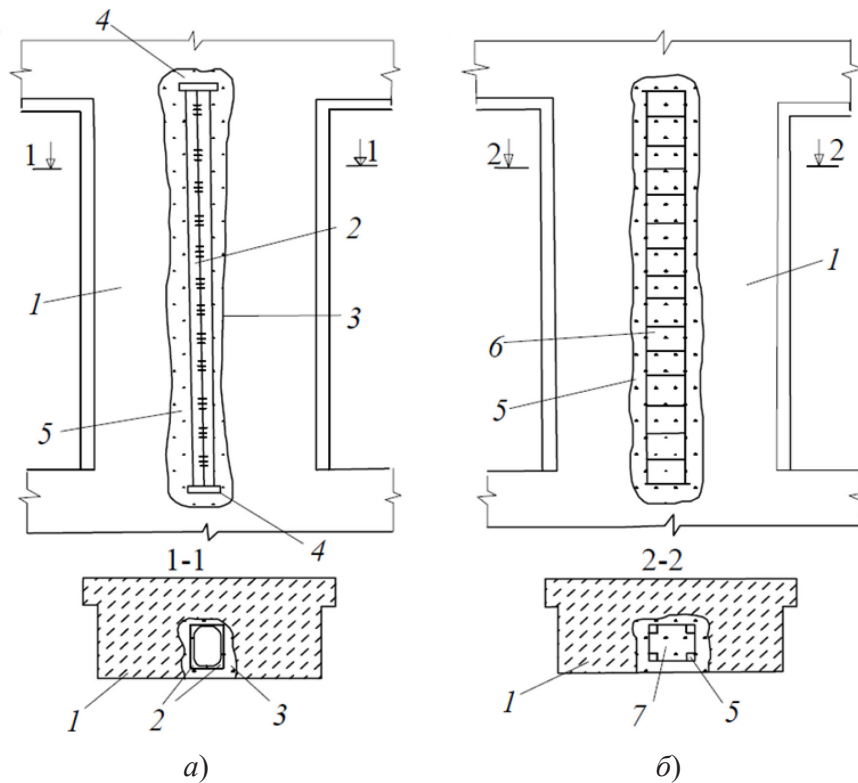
Усиление каменных простенков сердечниками: *а* – стального; *б* – железобетонного; *1* – усиливаемый простенок; *2* – стальной сердечник из двух сваренных швеллеров № 14; *3* – бетон класса В10–В15; *4* – опорная пластина; *5* – вертикальная штраба, прорезанная в простенке; *6* – пространственный арматурный каркас; *7* – бетон класса В20
